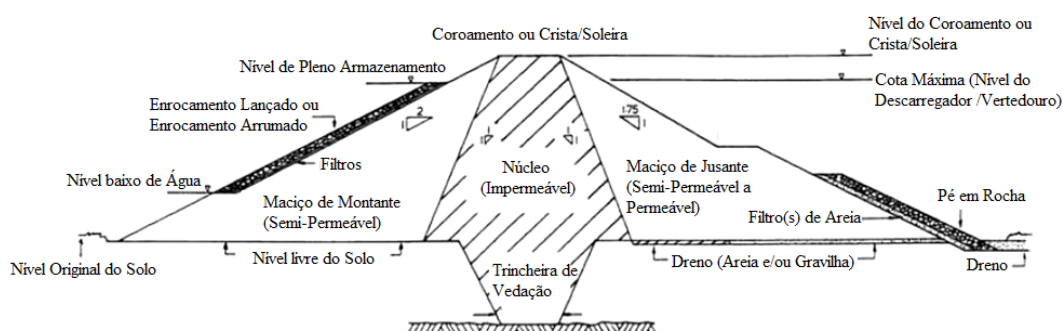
Perfil de uma barragem de perfil zonado (adaptado de Stephens, 2011)
